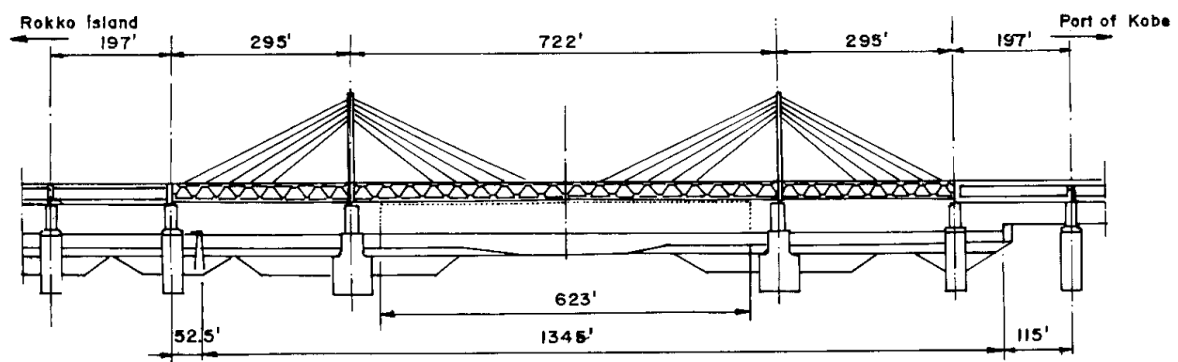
Alçado longitudinal da ponte Rokko (unidades em pés) [66]
